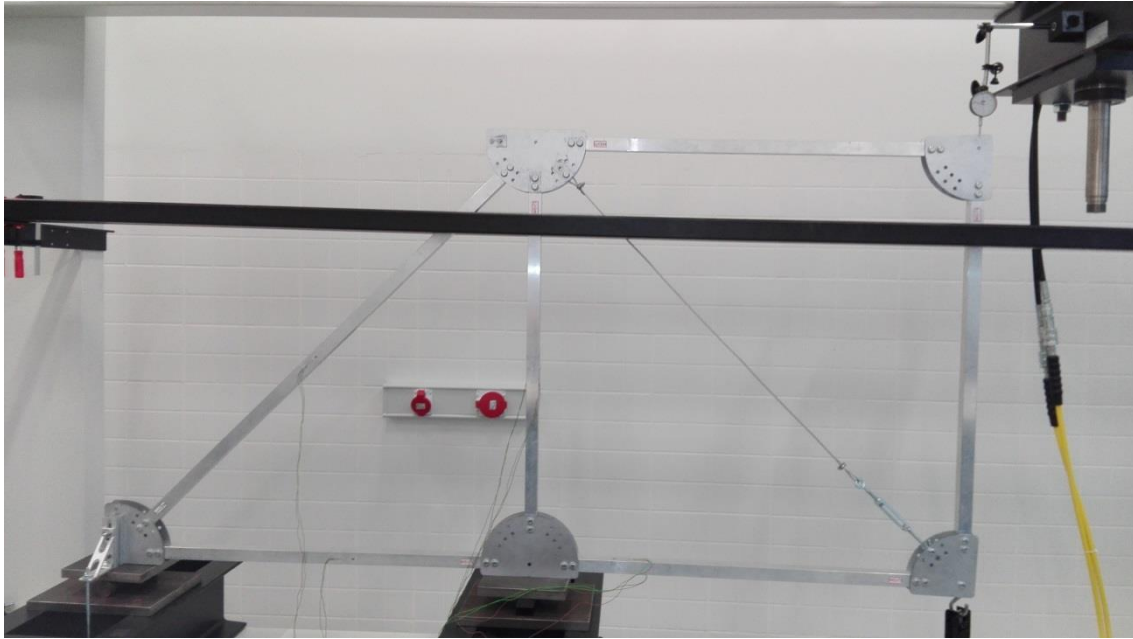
Sistema de anclaje vertical del apoyo izquierdo.
